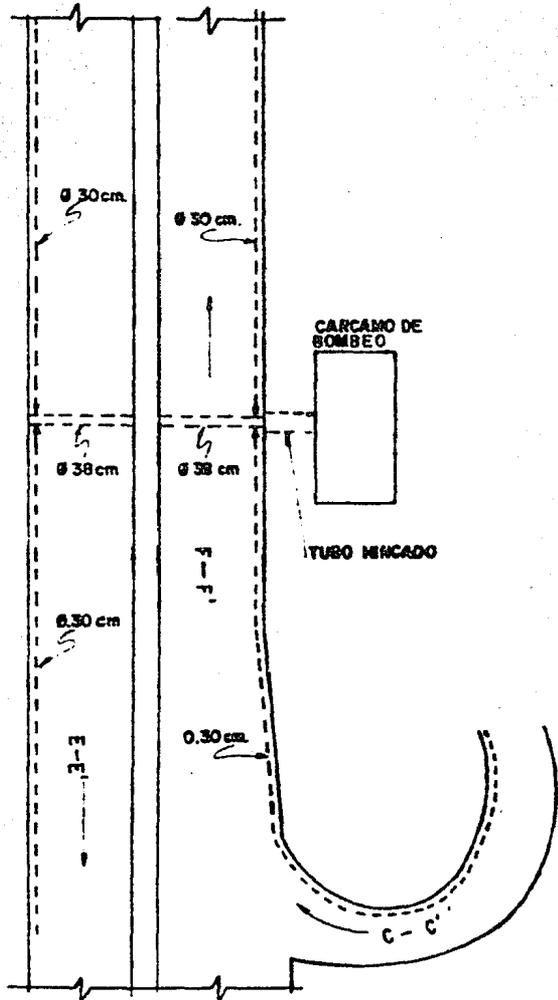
TUBERIA DE DRENAJE PLUVIAL
